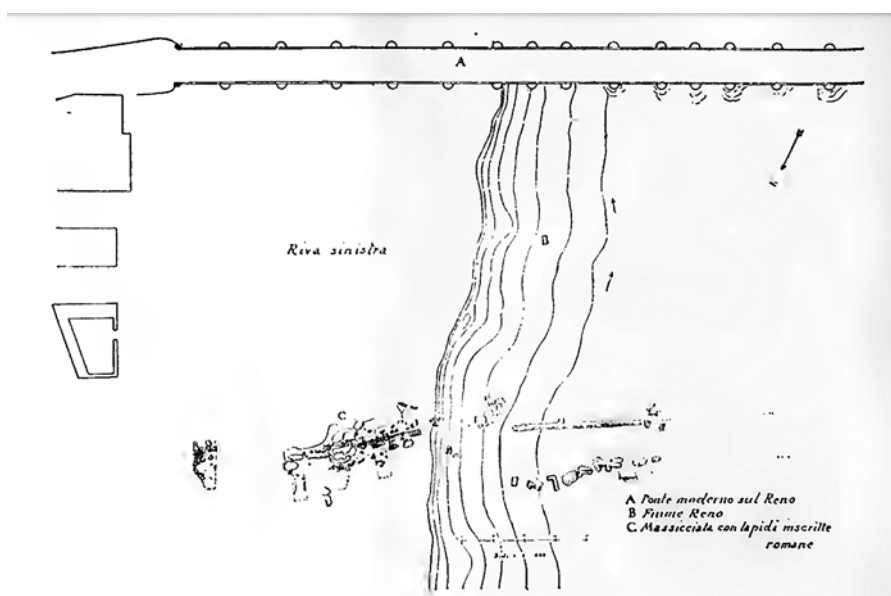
Pianta del cosiddetto «muro del Reno», da Ghirardini (1921).
